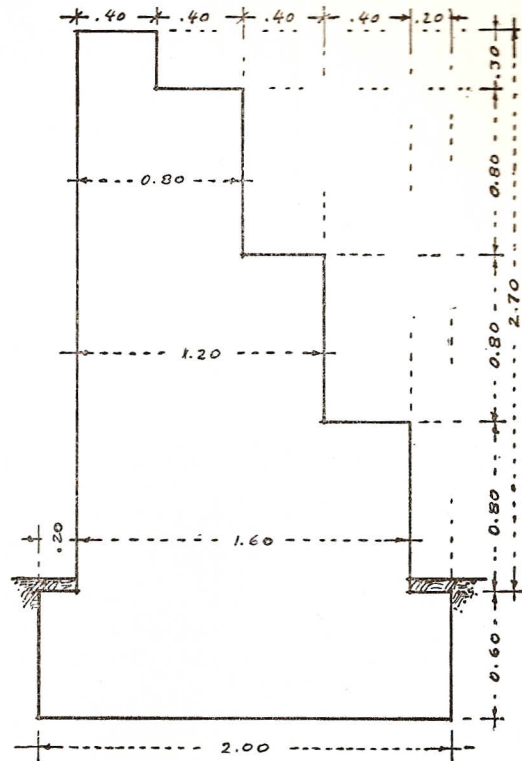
CORTE DE MURO DE SUPORTE DE PARAMENTO VERTICAL
